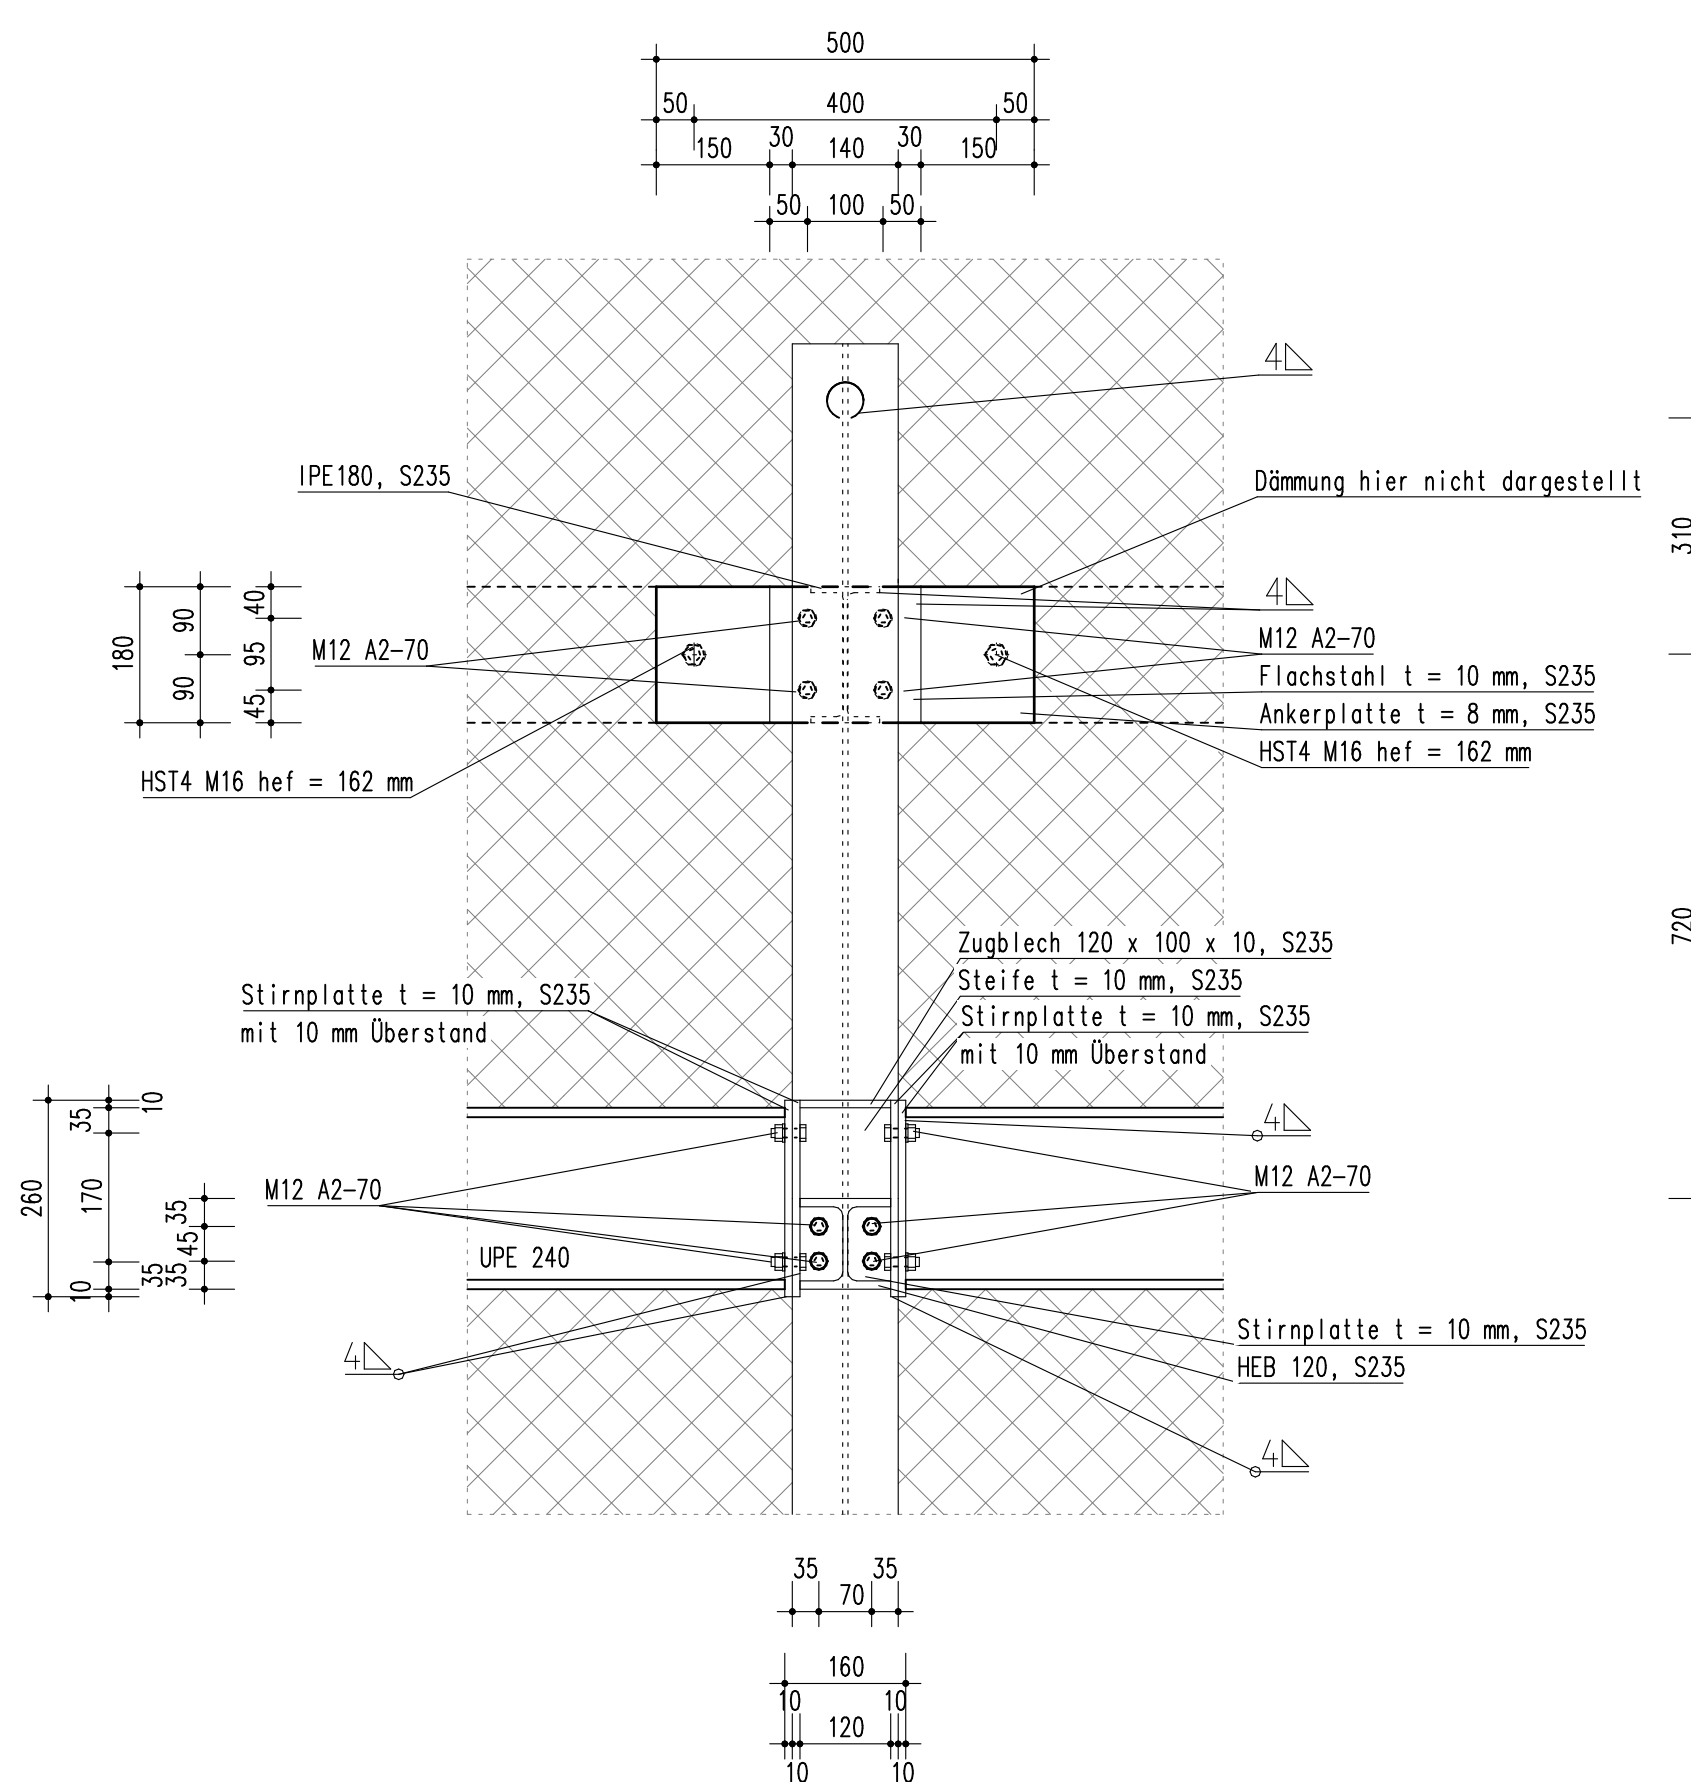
Anschluss an Bestand, sowie Augenstab und UPE
